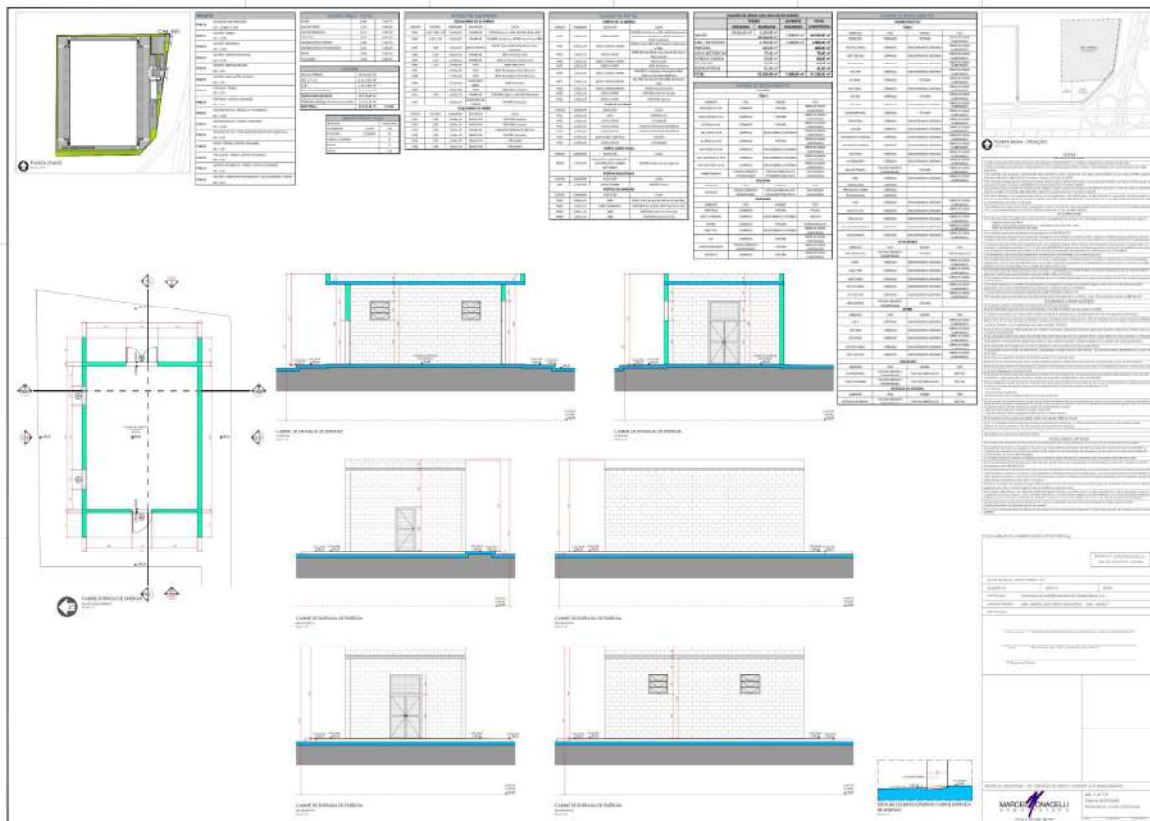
Cabine de Entrada – Planta Baixa, Cortes e Elevações, Fonte: Recorte do Projeto de Arquitetura – R09, em anexo.
